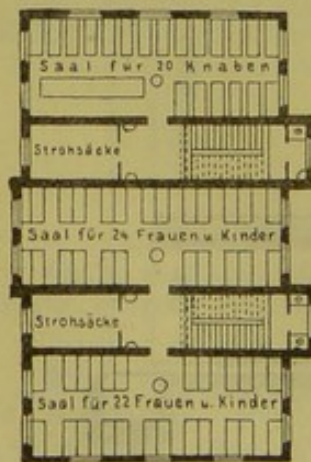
Städtisches Asyl zu Elberfeld. Grundriss des 1. Stocks.
